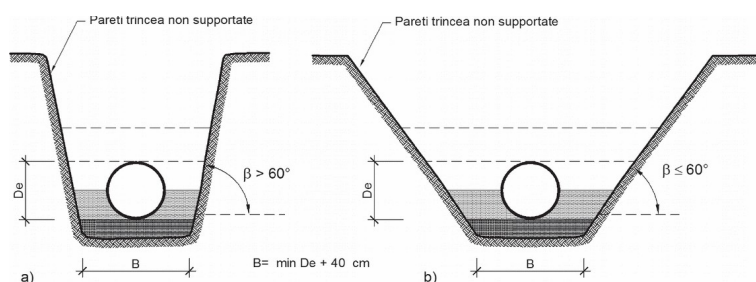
Angolo della parete della trincea senza cassatura rispetto all'orizzontale
